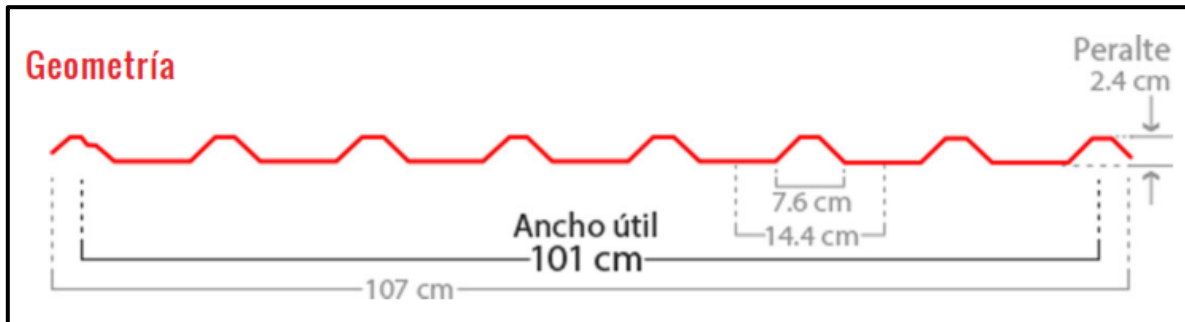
Geometría de una hoja de lámina galvanizada tipo R-101 (asbestos y aceros recubiertos. 2021)
